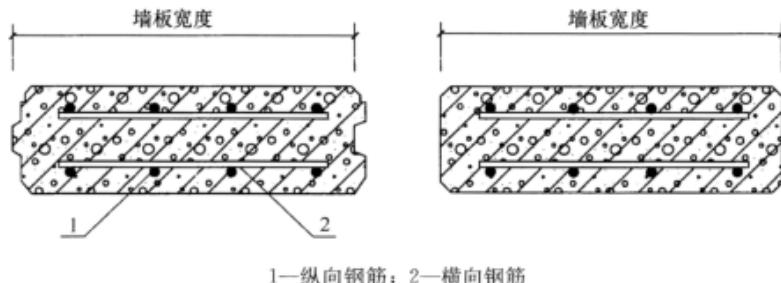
蒸压轻质混凝土墙板宽度及配筋示意
